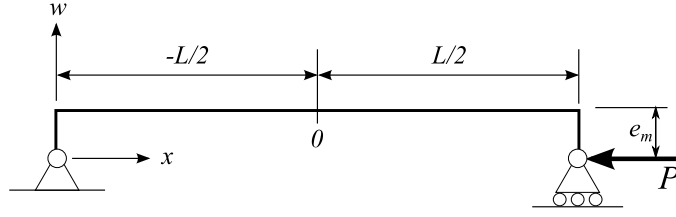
Elemento tubular corroído uniformemente sob compressão.
